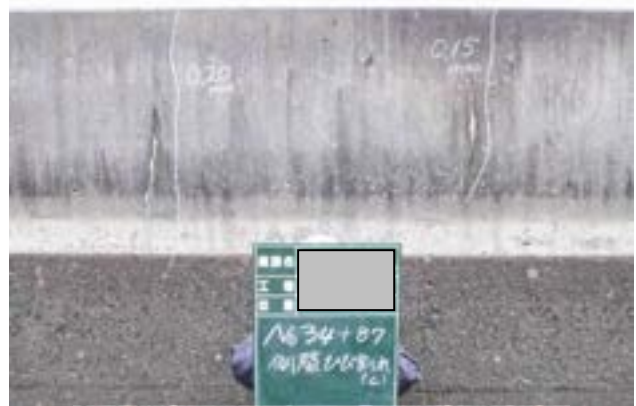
側壁部材の垂直ひび割れ
